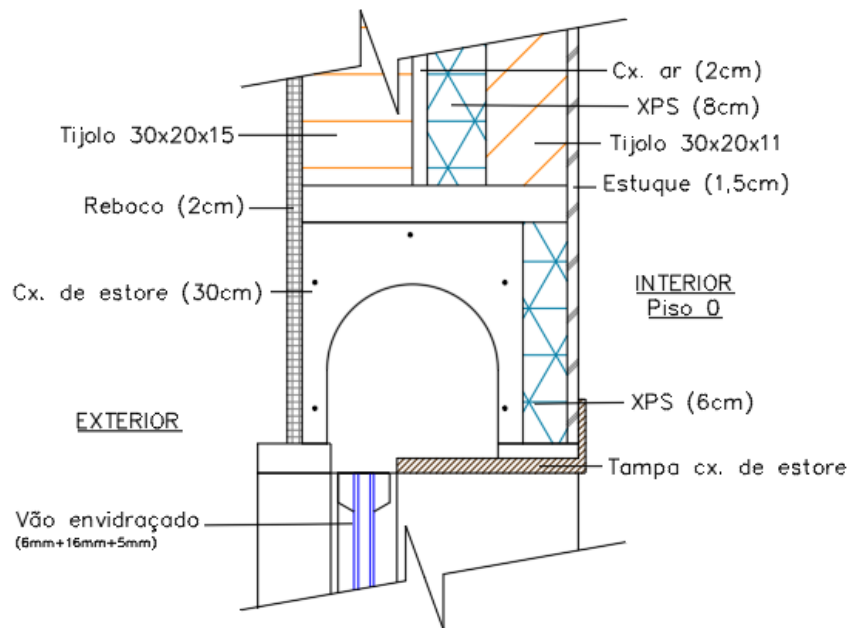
Exemplo de pormenor construtivo do vão envidraçado da proposta inicial
